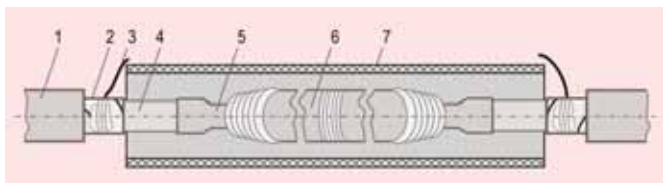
Подготовка к усадке внутренней трубки ТУТ на бронированном кабеле: 1 – наружный шланг; 2 – броня; 3 – подброневая полиэтиленовая оболочка; 4 – ТУТ продольной герметизации; 5 – каркас; 6 – внутренняя ТУТ, подготовленная к усадке
